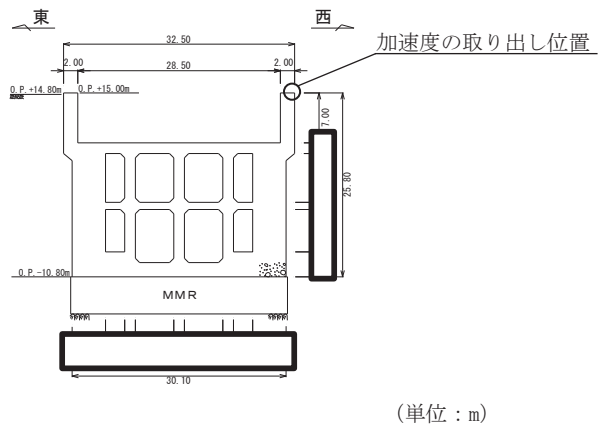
(2) 海水ポンプ室断面図 (スクリーンエリア) (A-A 断面)
